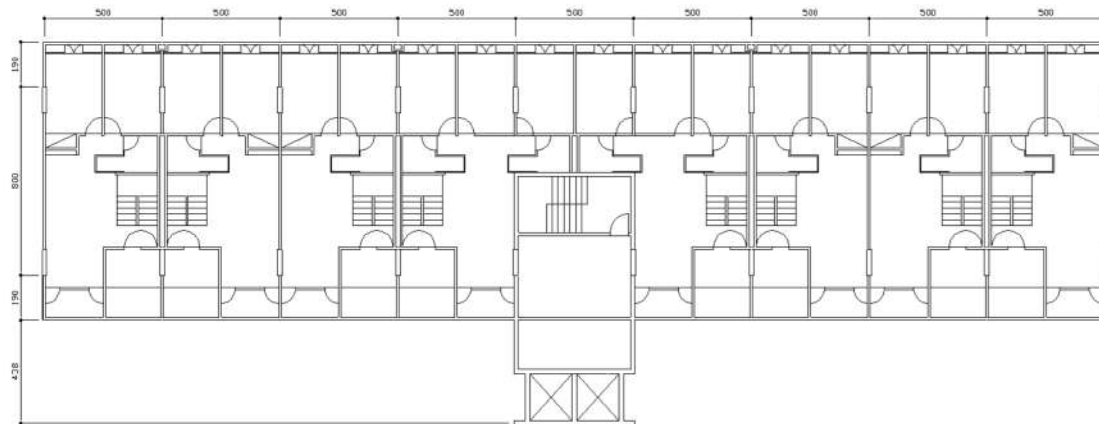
Planta de arquitetura dos pavimentos inferior e superior
